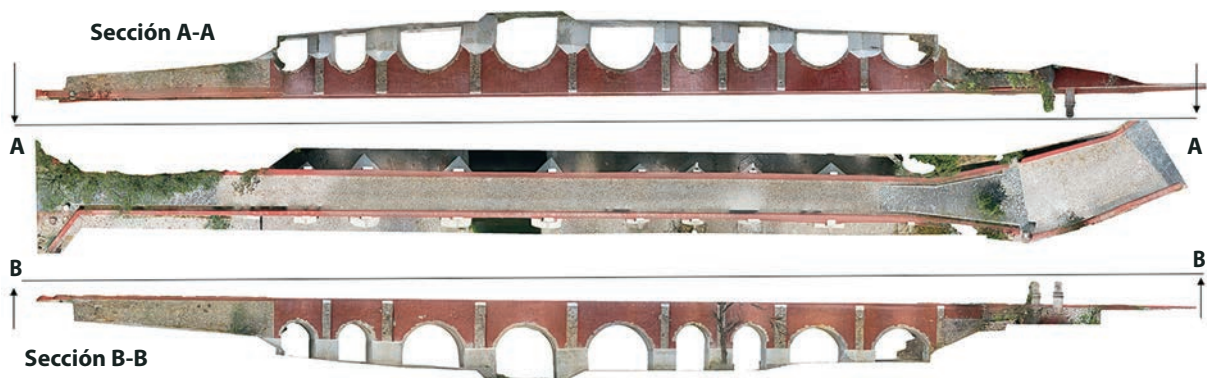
Ortofotos de planta y fachadas, puente de San Ignacio.
